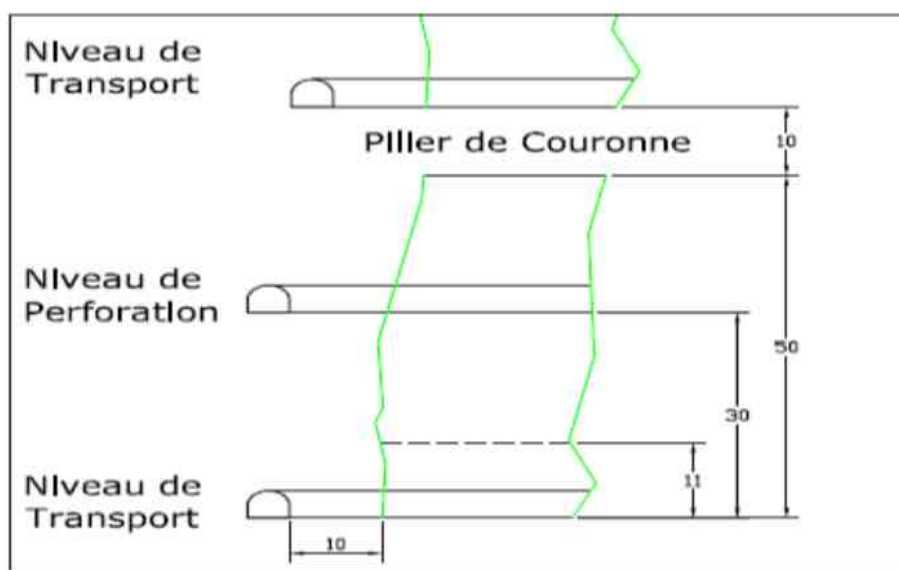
Coupe transversale, chantier type (Amec, 2011).
